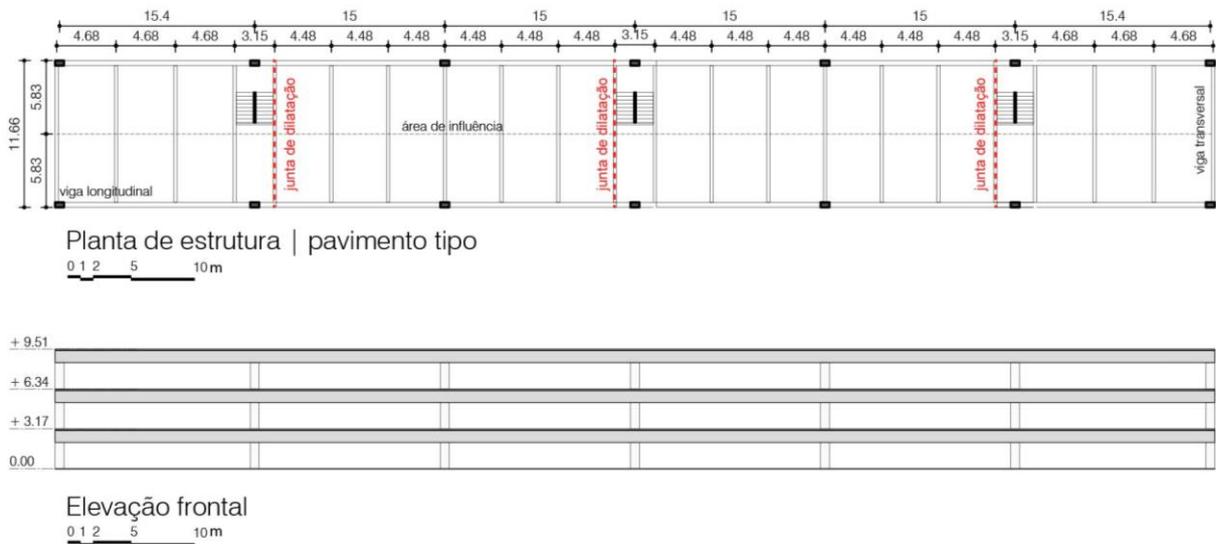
Planta estrutural e elevação frontal da simulação 4: Elaborado pelo autor
